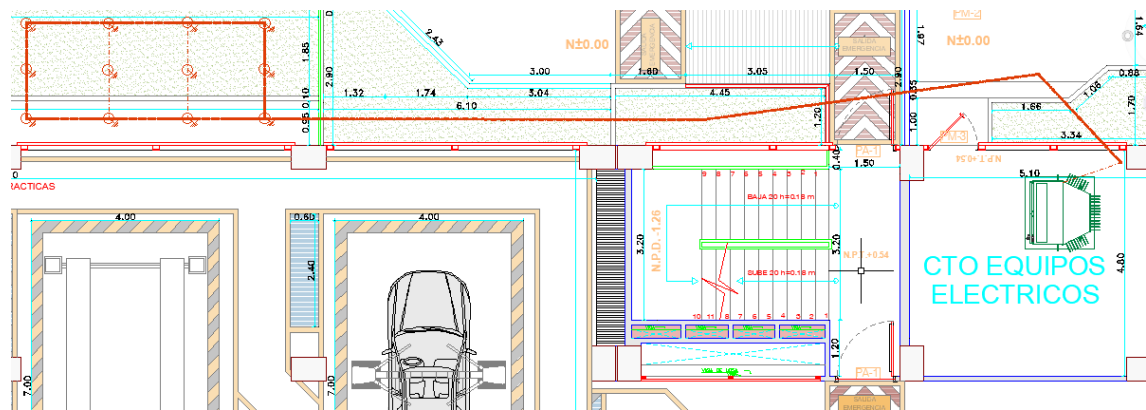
Plano eléctrico del sistema de puesta a tierra existente bloque E.
